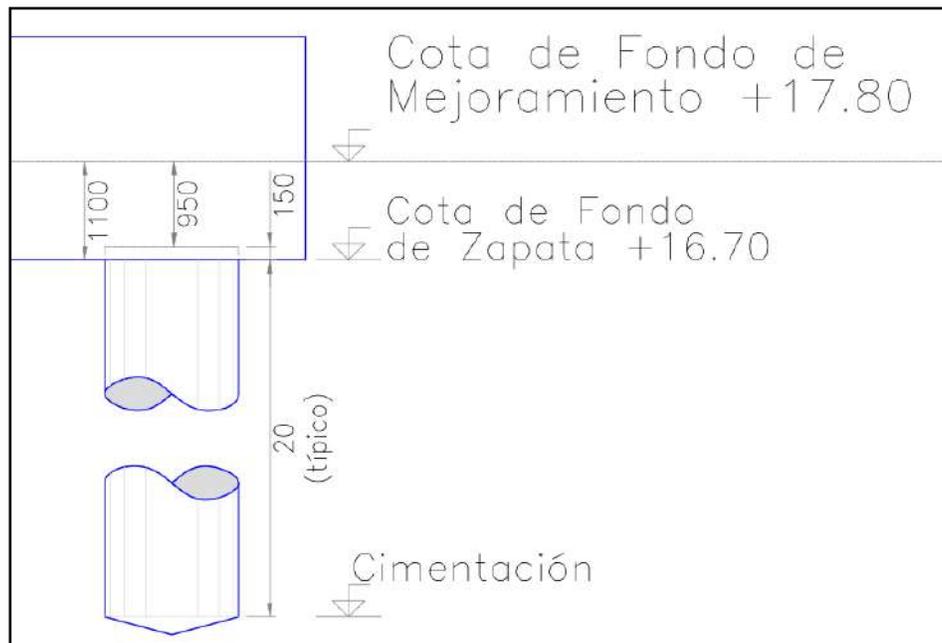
Detalle de cota de Plataforma de Pilotaje en Pilares
